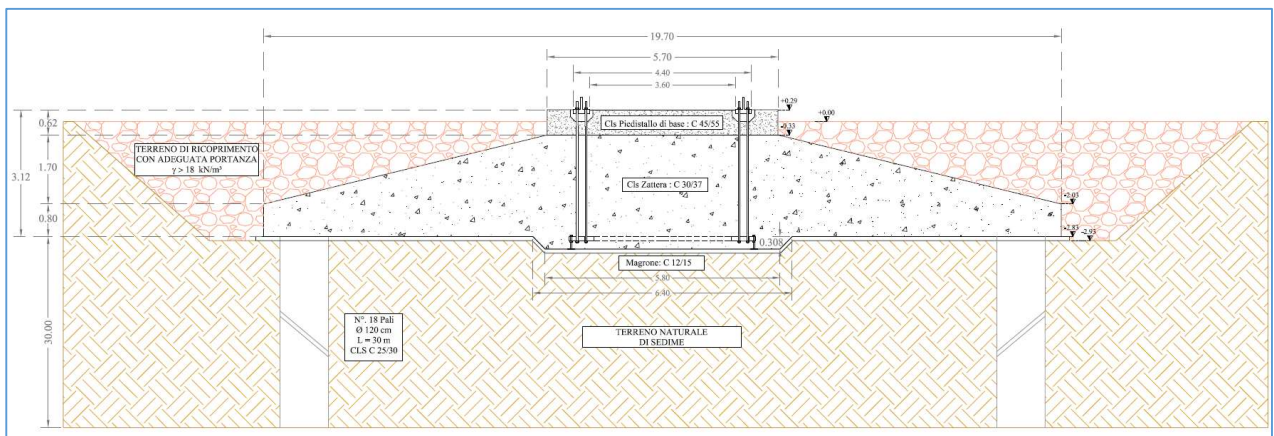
Sezione tipo fondazione Aerogeneratore.
